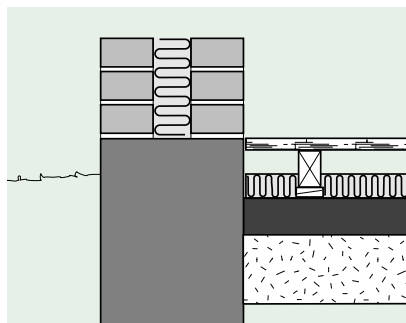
Terrændæk med gulvbrædder, gulvstrøer på kiler, isolering, fugtspærre, betonlag samt singels.
